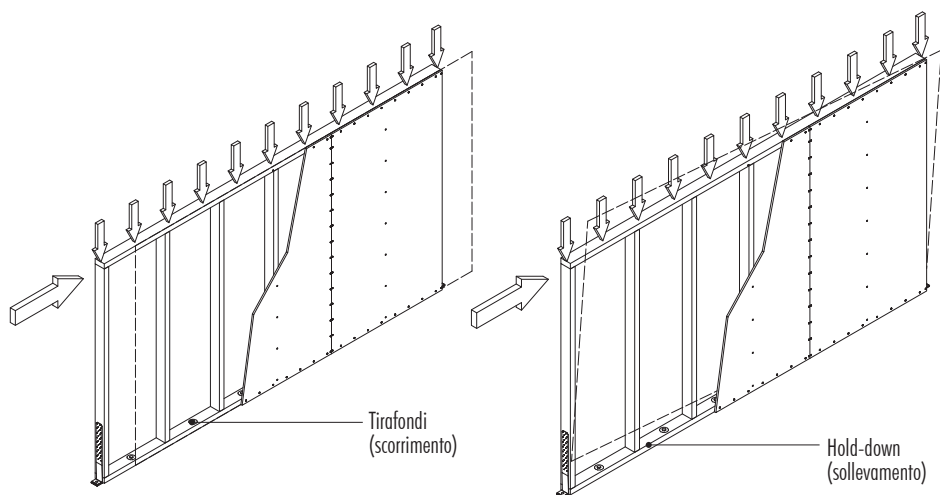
Parete Platform soggetta ad azioni orizzontali nel piano. Le azioni di scorrimento e sollevamento vengono contrastate mediante tirafondi e hold-down (nota: per chiarezza in questo disegno gli hold-down sono posizionati all'esterno del telaio della parete, ma solitamente vengono posizionati al suo interno).
